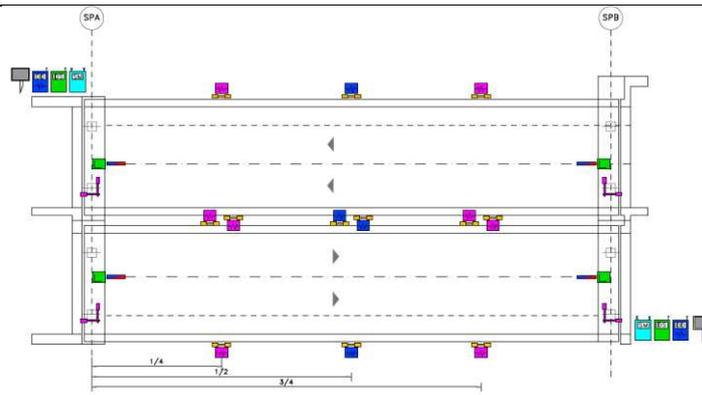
Schema soletta impalcato posizionamento strumentazione ponti
